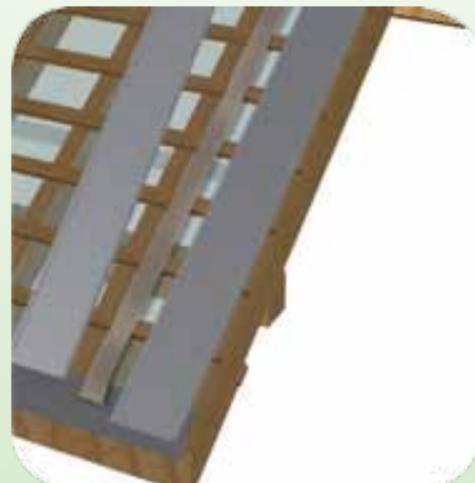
Schallschutzmatte – empfohlen bei Stahlkonstruktionen
